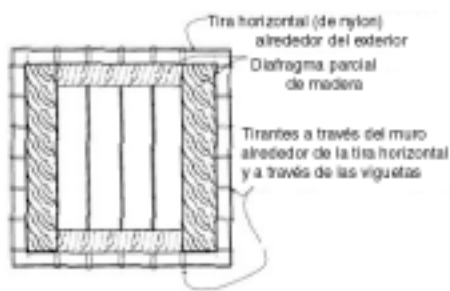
Planta del Ático del Módulo Ensayado, Mostrando Medidas de Reforzamiento Aplicadas al nivel del Piso (Tolles y otros, 2000)
